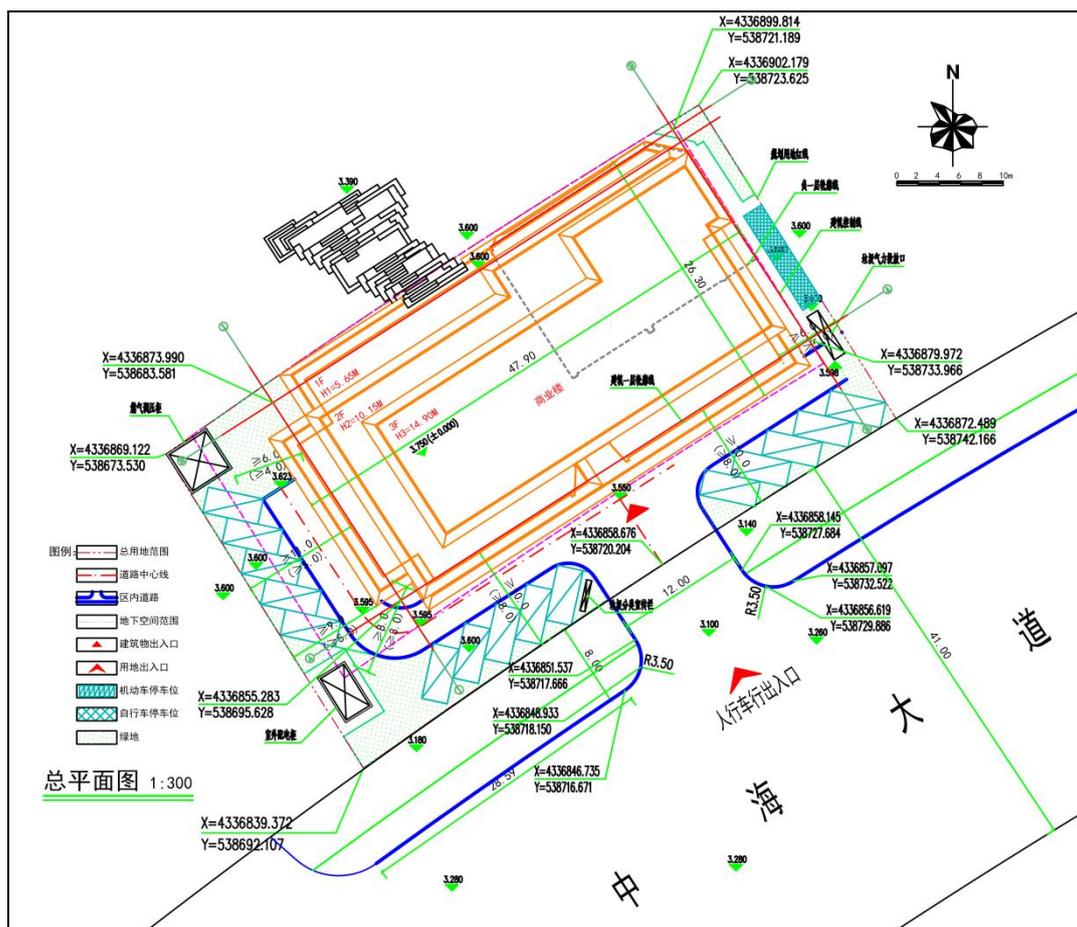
69b-2 号地 03-02-09 地块总平面布置
